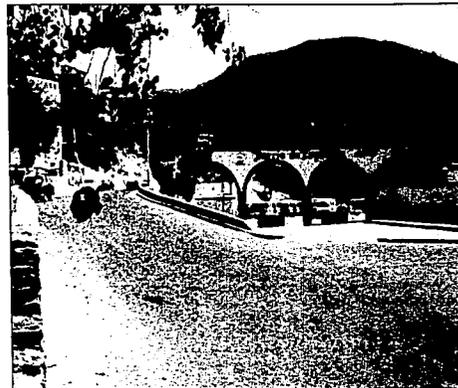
Vista de calle principal al acceso del terreno (estado actual)
